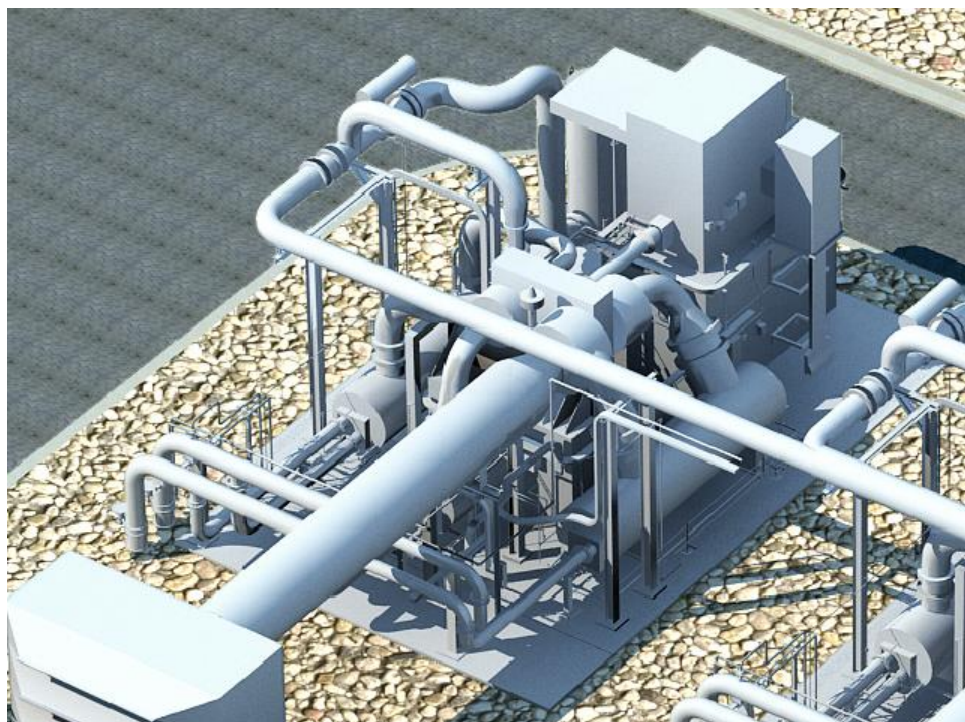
Modelo estrutural: vista isométrica do conjunto fundação-equipamento (Maquete 3D)
